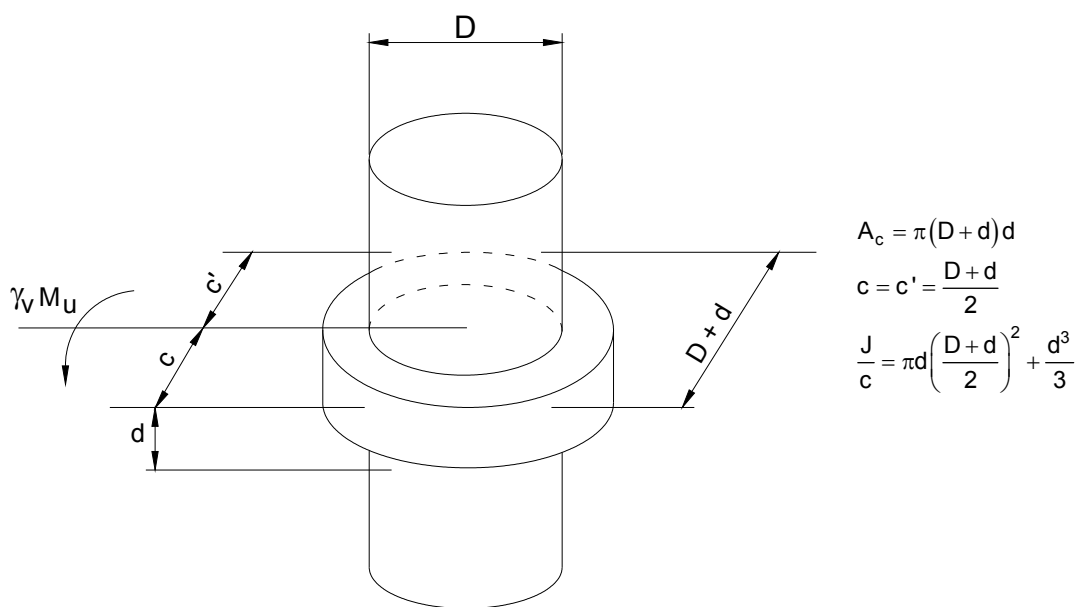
Propiedades de las secciones para el cálculo de las tensiones de corte - Columnas circulares interiores
